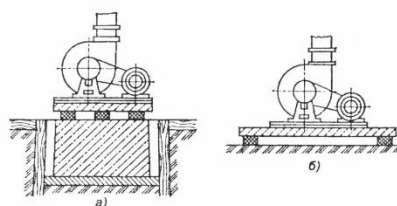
Установка агрегатов на виброгасящем основании: а – на фундаменте и грунте; б – на перекрытии
